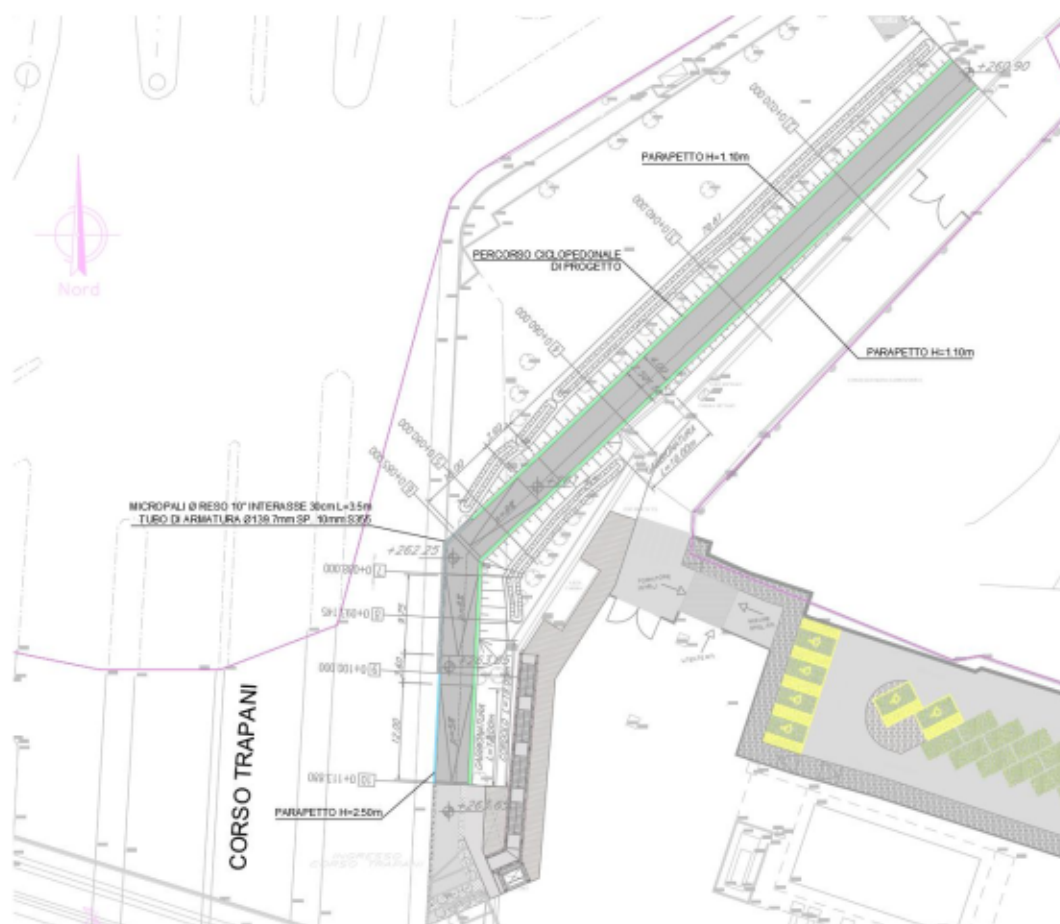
Planimetria di progetto - Percorso ciclopedonale
